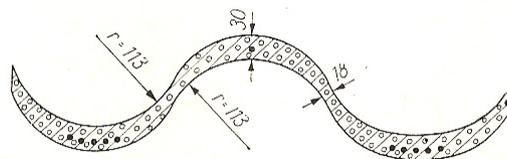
Wellbetondachelement, Betongute B300, Spannstahl St 150, aus HERHOLDT [3]
